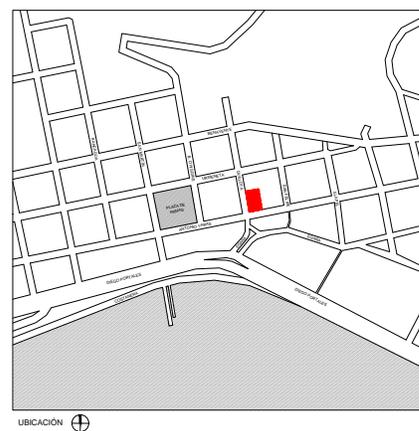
Planta de ubicación de la Casa del Arte Diego Rivera, Puerto Montt. (fuente: planimetría de Anabella Benavides Vega sobre original de Raúl Bulnes Calderón).
